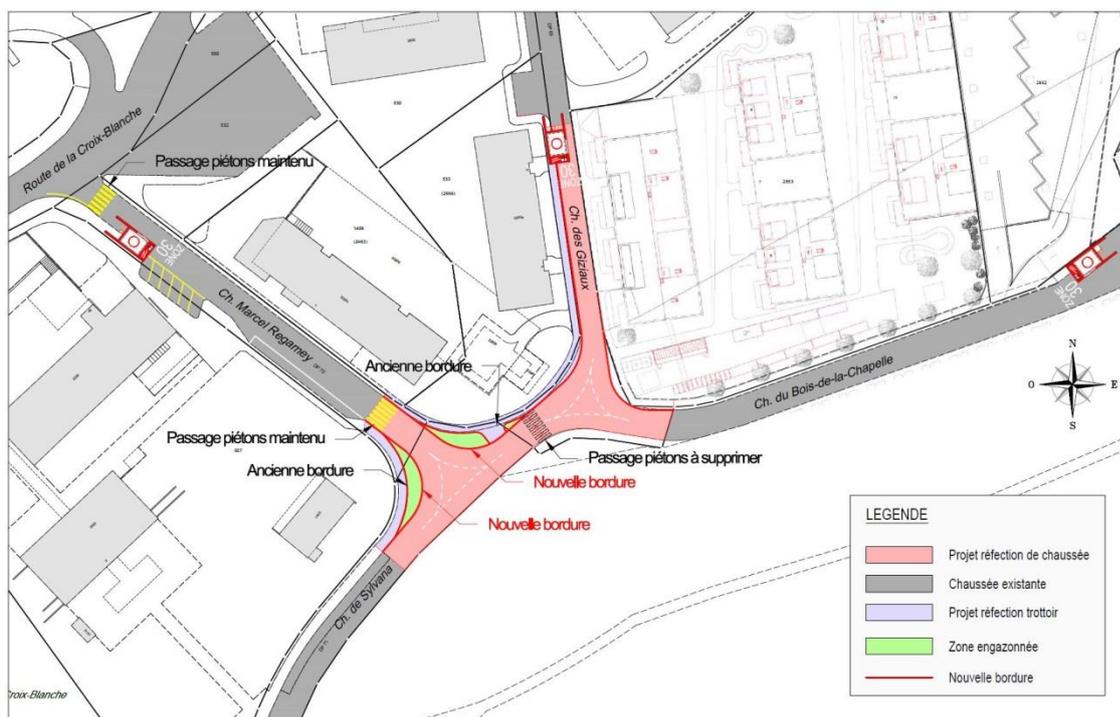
Plan des travaux au niveau du carrefour du Ch. du Giziaux / Ch. Marcel-Regamey
